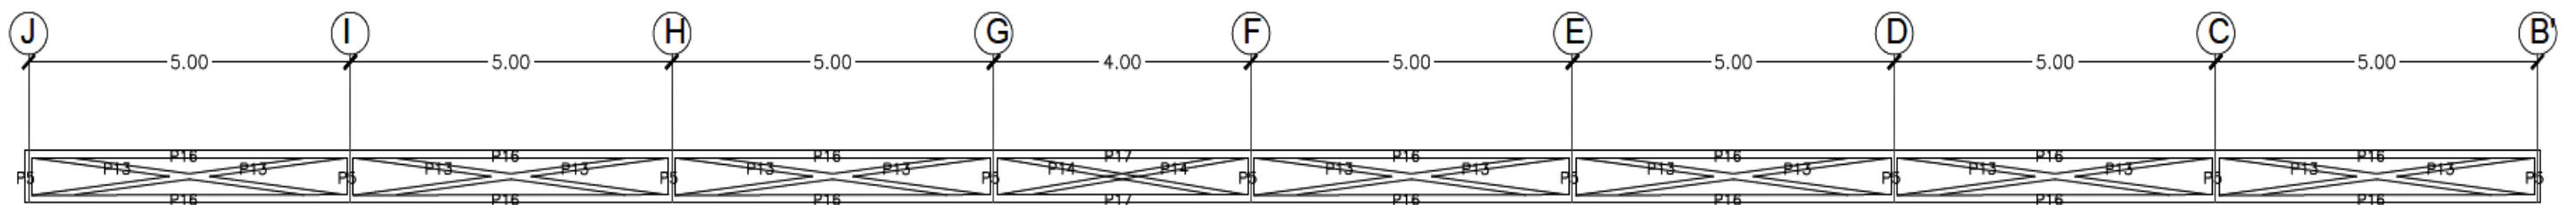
Detalle de la correa de anclamiento—Ejes señalados en la vista en planta
